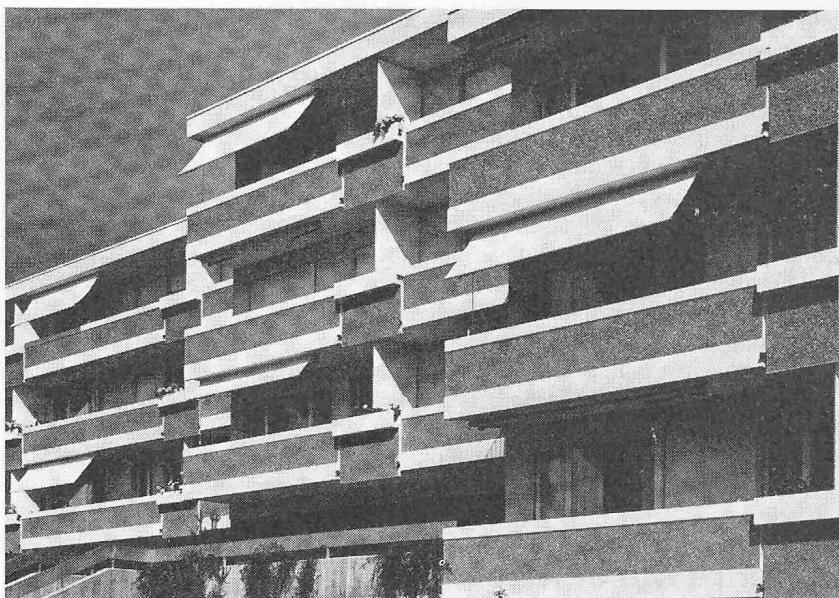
Wohnhaus in Biel mit Balkonbrüstungen in Wasch- und Sichtbeton
